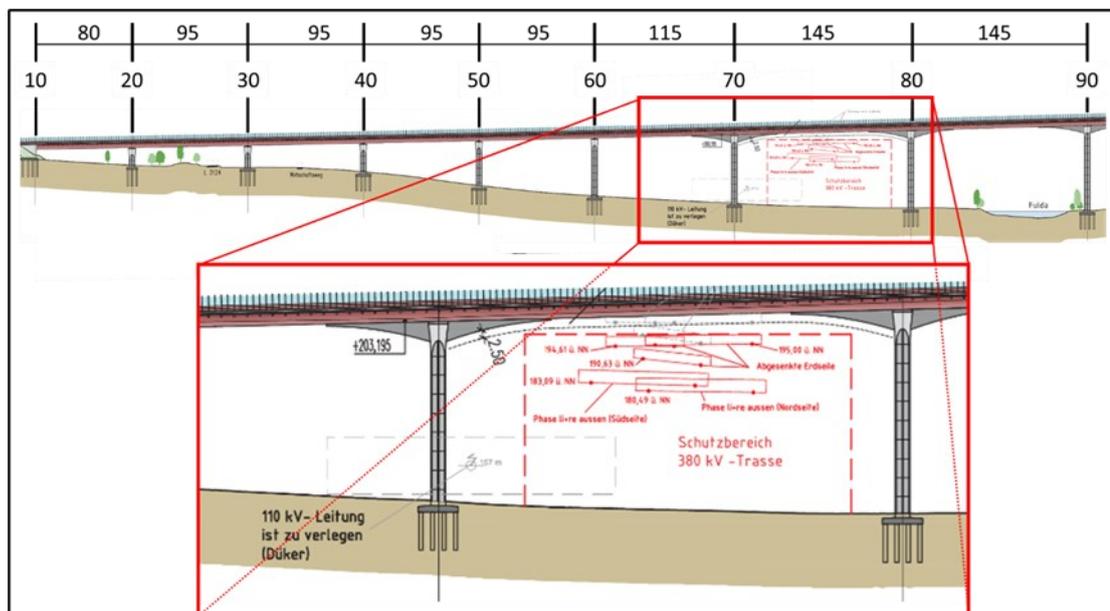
Ausschnitt aus dem Übersichtsplan zur Variante 3 der Machbarkeitsstudie (SCHÜLLER PLAN 2019); Längsschnitt der Brücke mit Verlauf im SPA-Gebiet
